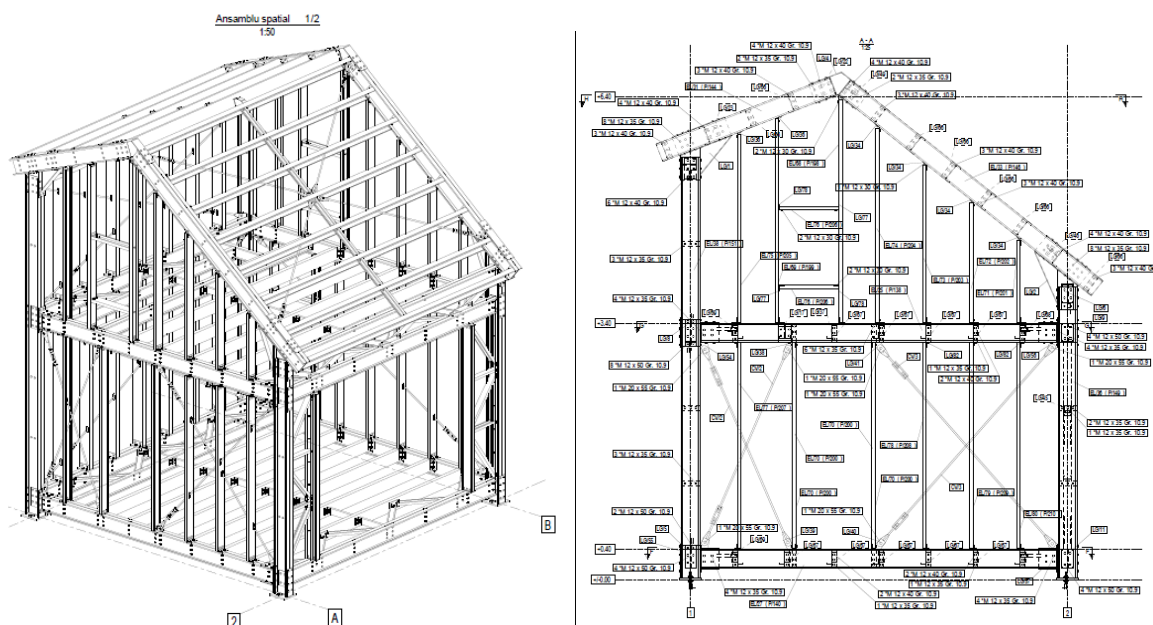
Proiectul de execuție al structurii: plan 3D și plan de asamblare perete (exemplu)
